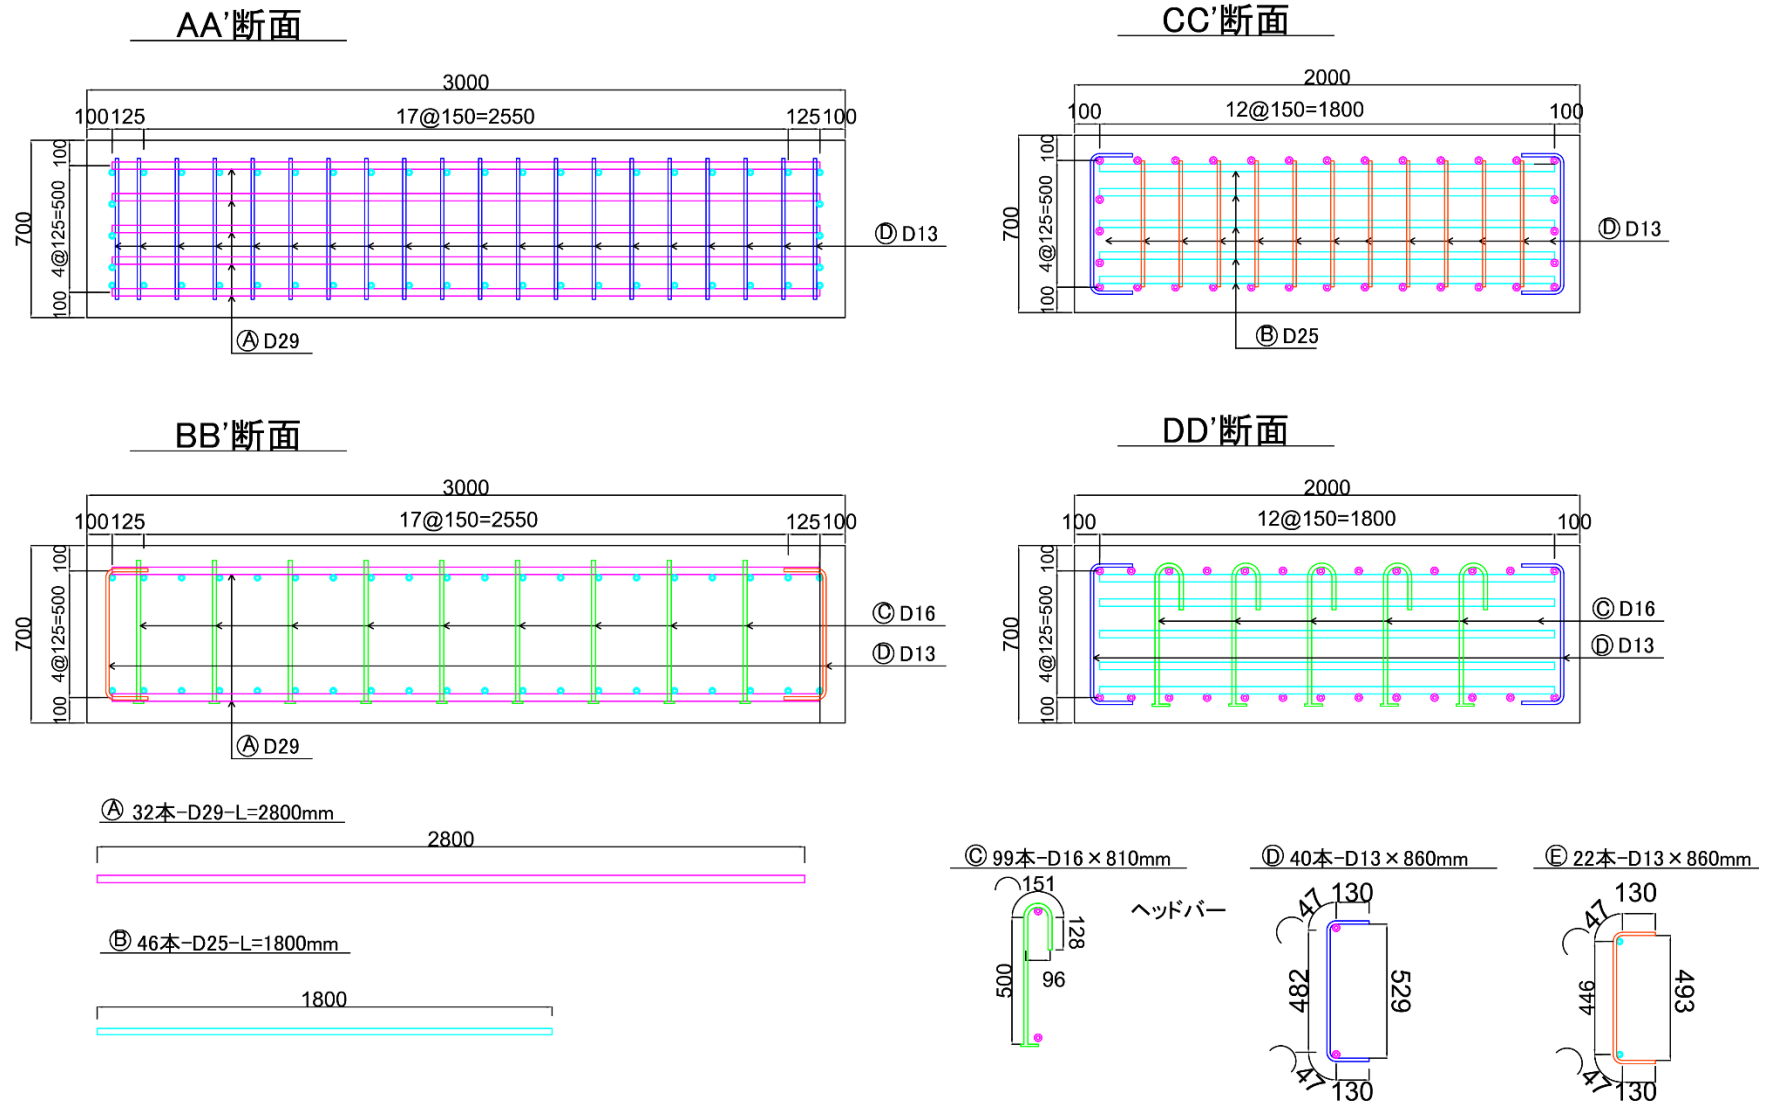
鉄筋コンクリート試験体の配筋図 (断面図と鉄筋詳細図)
